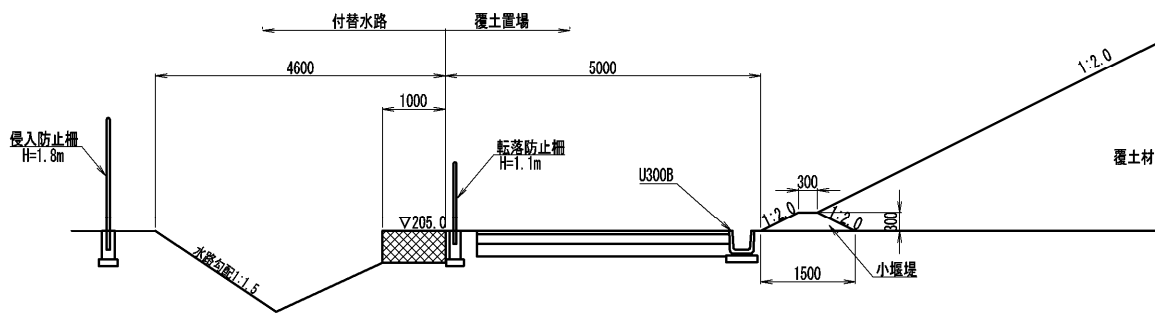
2 7 覆土置場の標準断面図 (A - A 断面)
